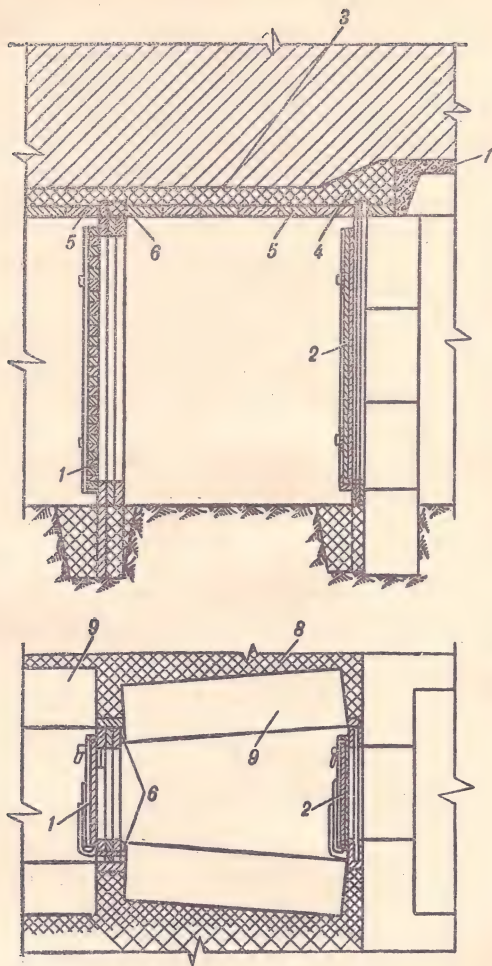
Узлы примыкания дверных блоков во входах со стенами из железобетонных блоков:
